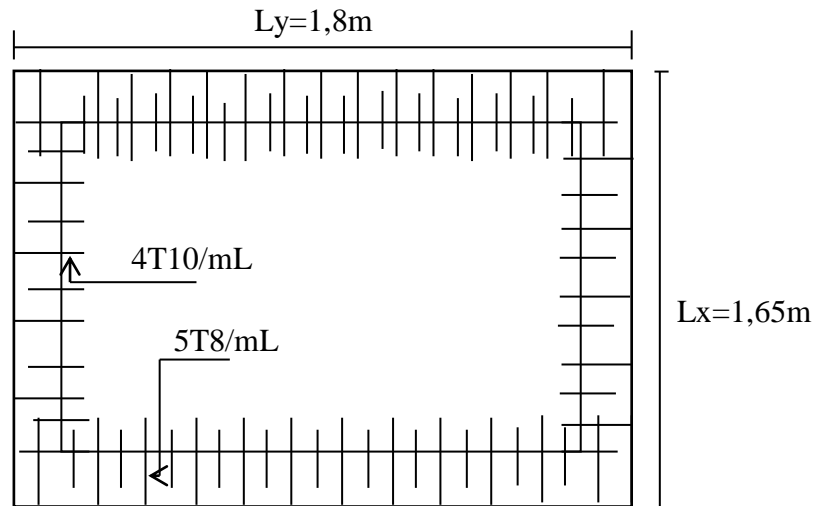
Ferrailage Supérieur du panneau de dalle.
